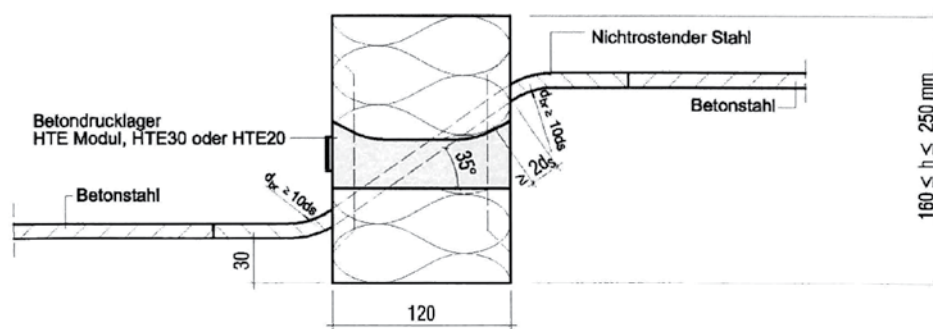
Schöck Isokorb Typ Q¹⁾ mit Betondrucklager
